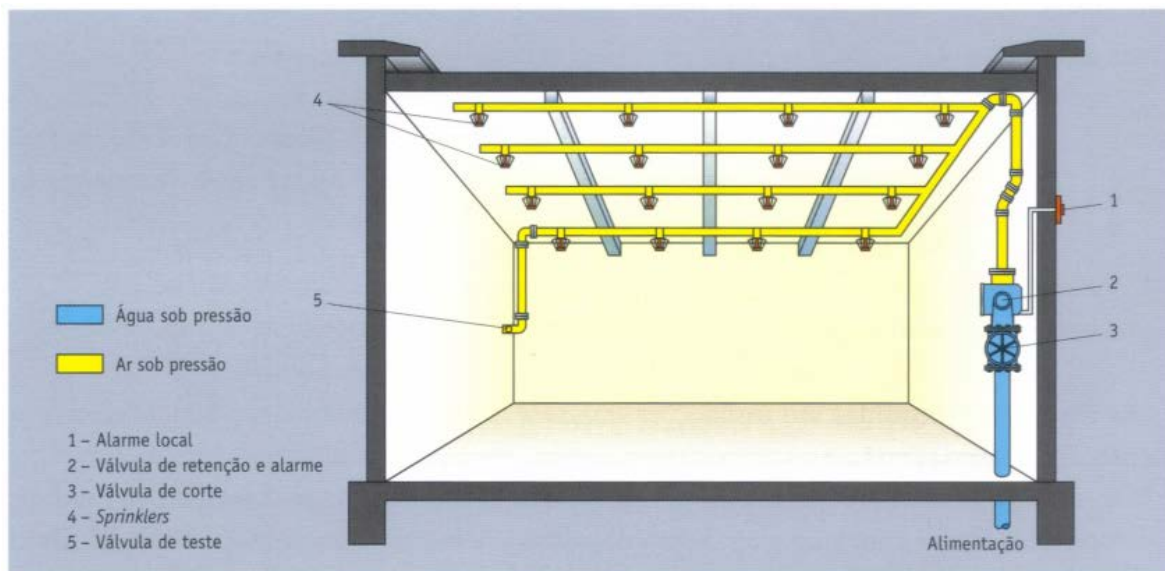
Instalação de sprinklers seca (dry pipe system) [4].
